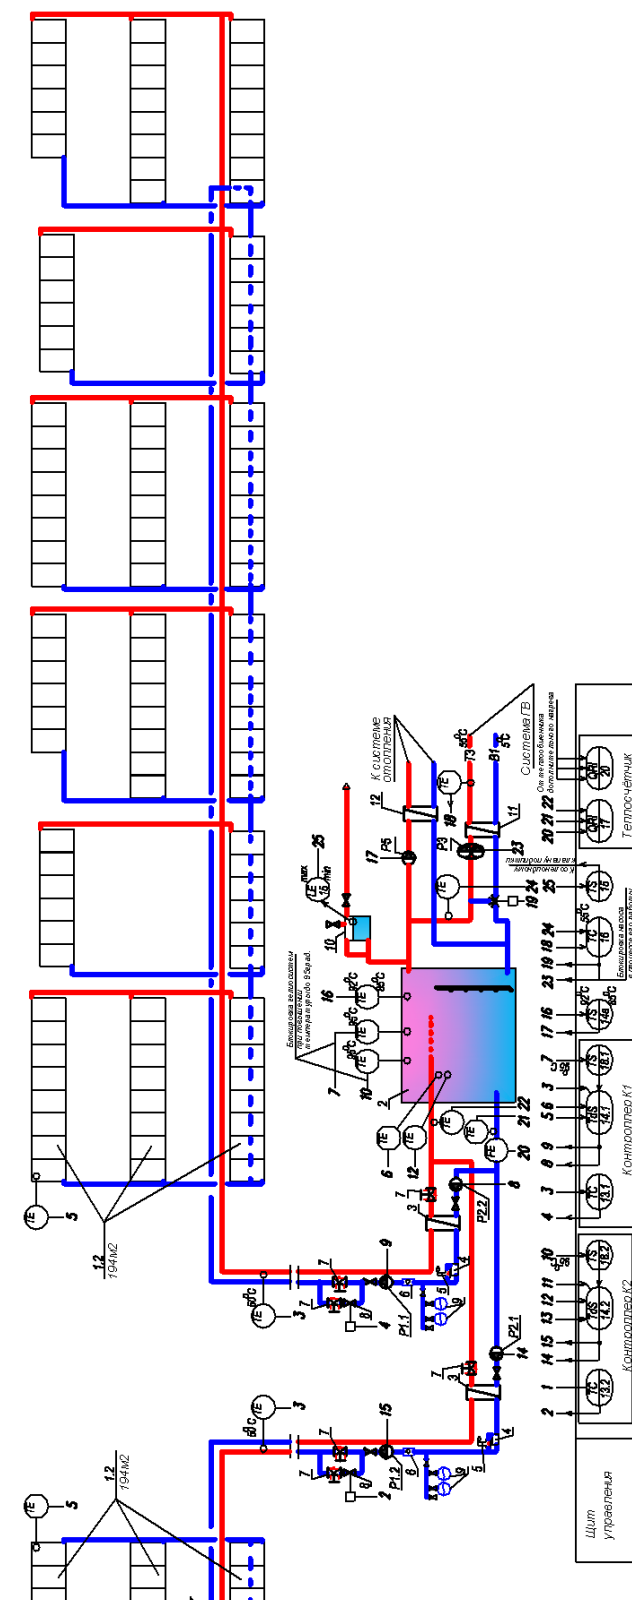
Схема геосистемы 160-ти квартирного 10-ти этажного жилого дома 1-геоколлекторы по 194м²; 2-буферный бак 12м³; 3- теплообменники; 4-воздухосборник; 5-сепаратор воздушный; 6-расходомер; 7-балансовый вентиль минимального расхода; 8-клапан повышения расхода; 9,10-расширительные баки; 11,12- теплообменники; 13-пропорциональный регулятор; 14(14а)-контроллер геосистемы; 15-датчик уровня системы подпитки.
